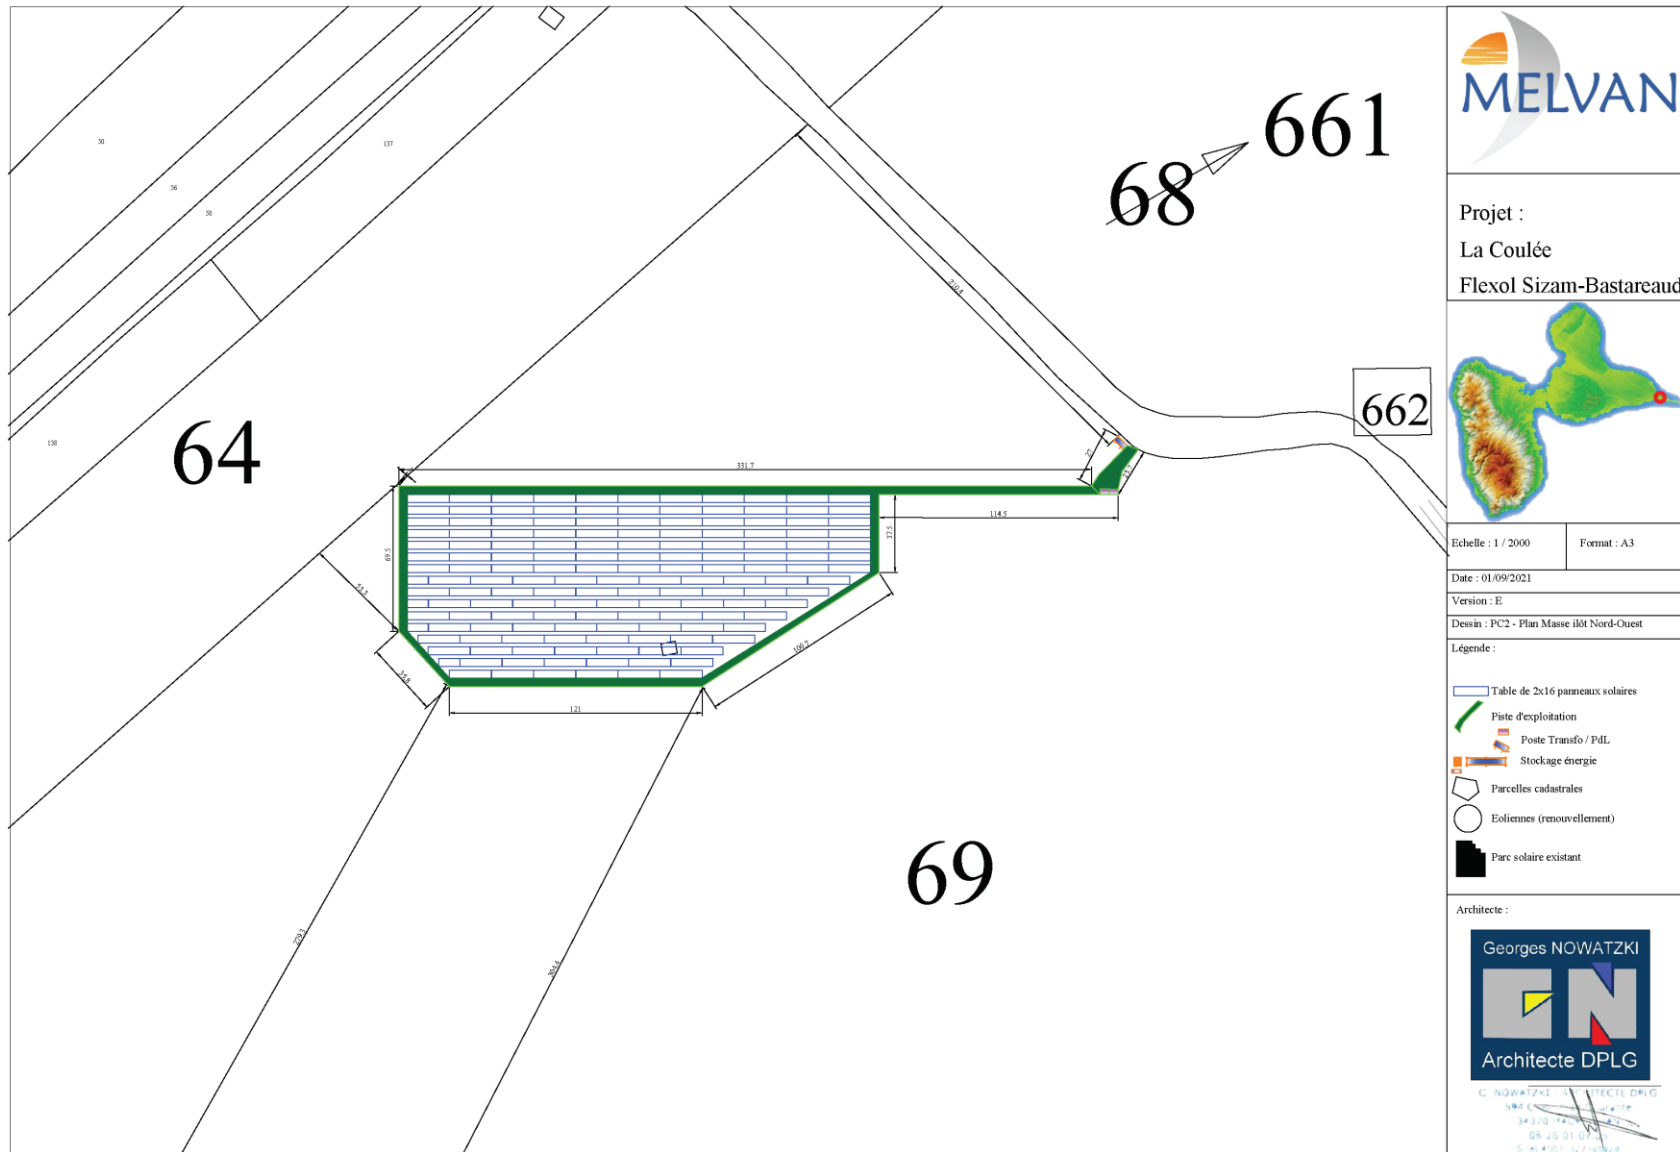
Plan de masse du parc Nord-Ouest (Melvan)
